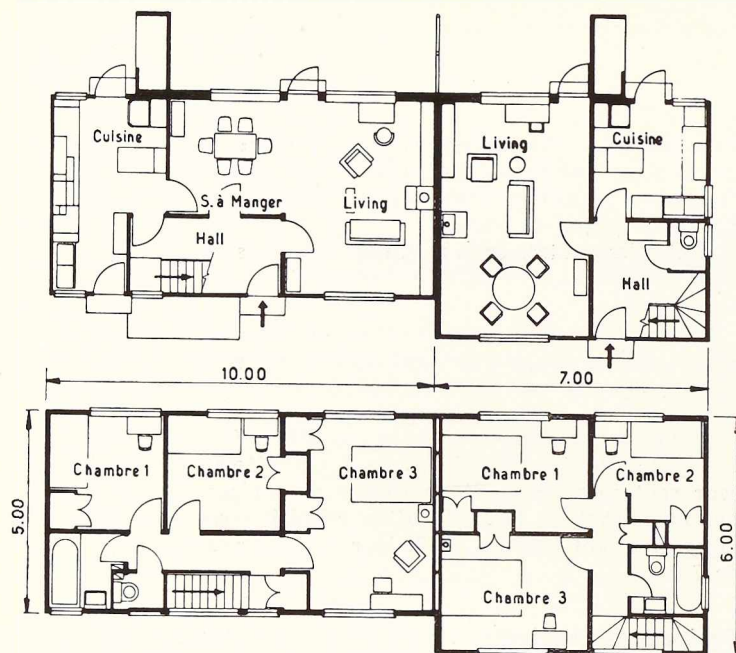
Plans du rez-de-chaussée et du premier étage.
